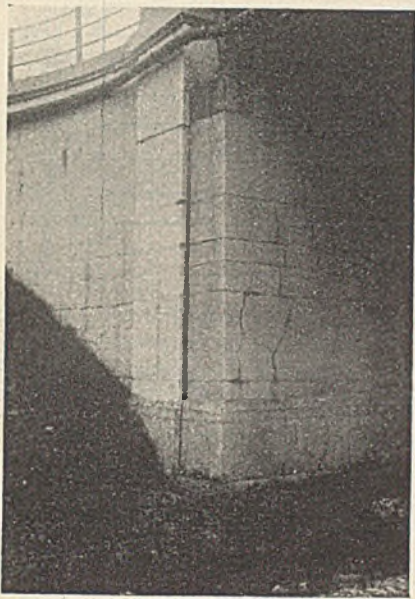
Brückenwiderlager in Stampfbeton 1:10, mit Vorsatz 1:4.
